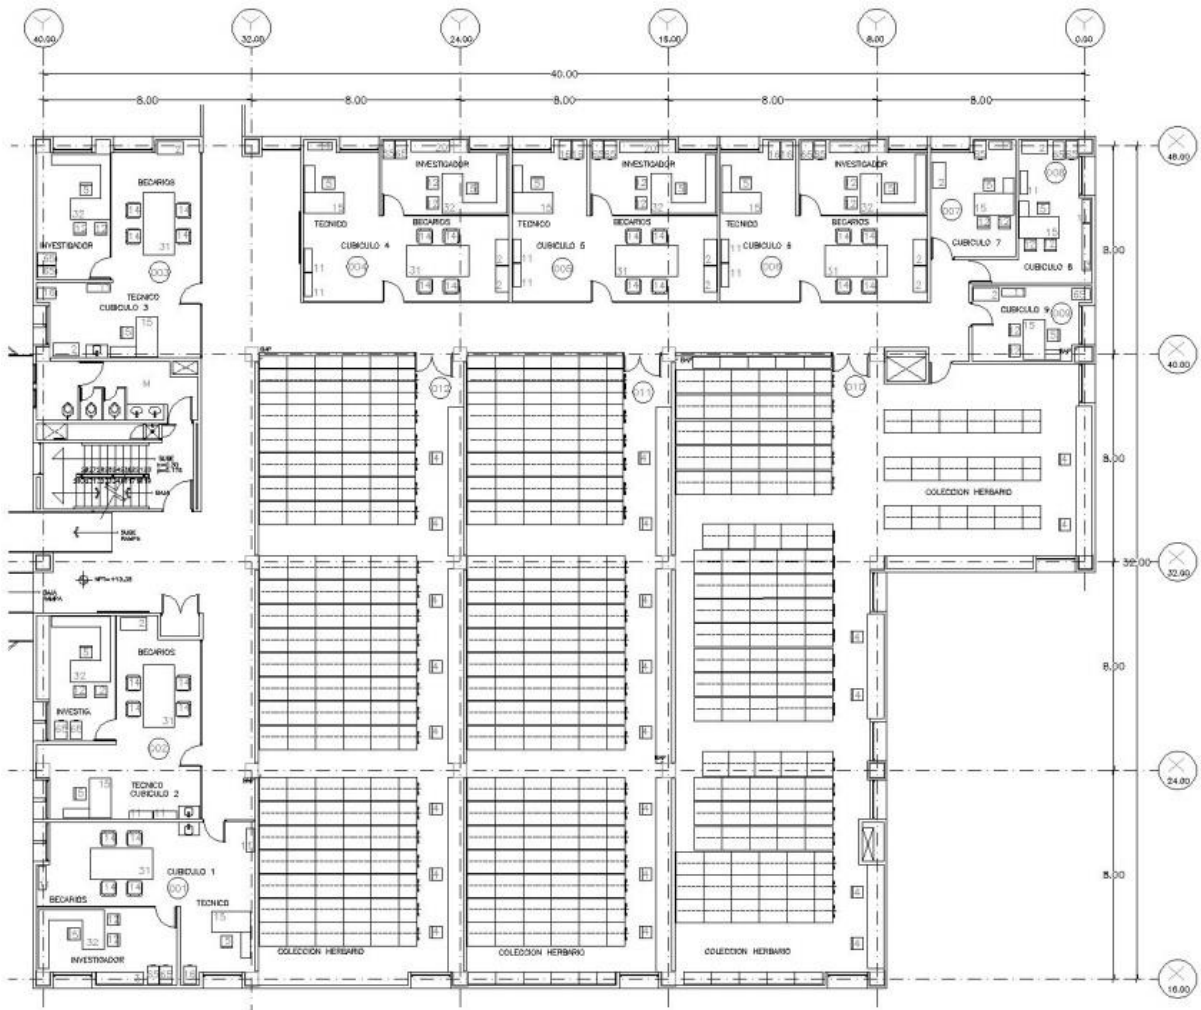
Planta de conjunto de IB UNAM. Recuperada de planos originales.
